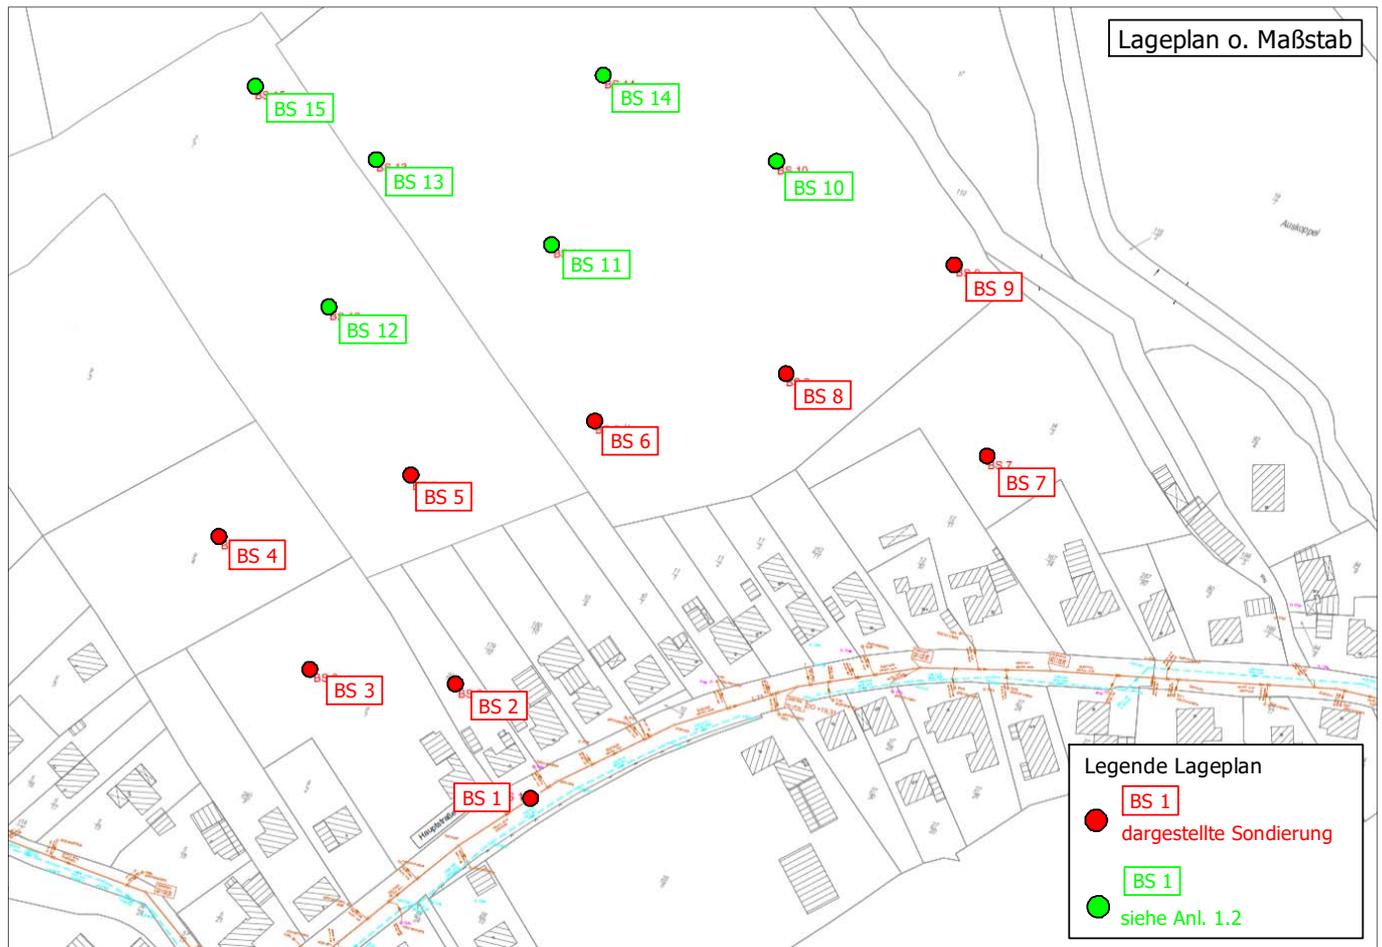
Ausschnitt Lageplan Anl. 1.1 (o. M.)
